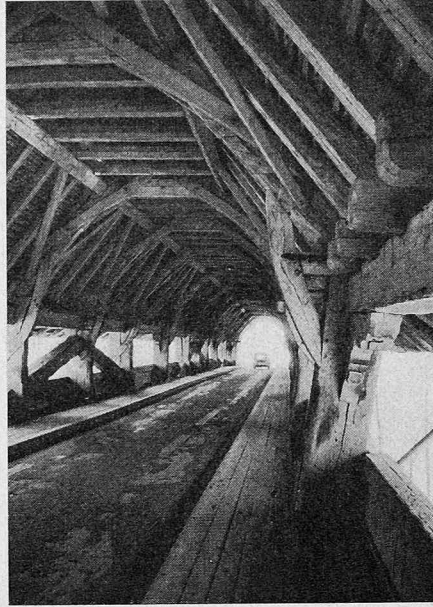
Aarberg: Dachbinder mit über 15% schief gestelltem Eichenpfosten, gekrümmte Druckbüge in mittlerer Ecke, obere Ecken nachträglich versteift, untere Ecke siehe Bild 5 (Horizontalschub!)
